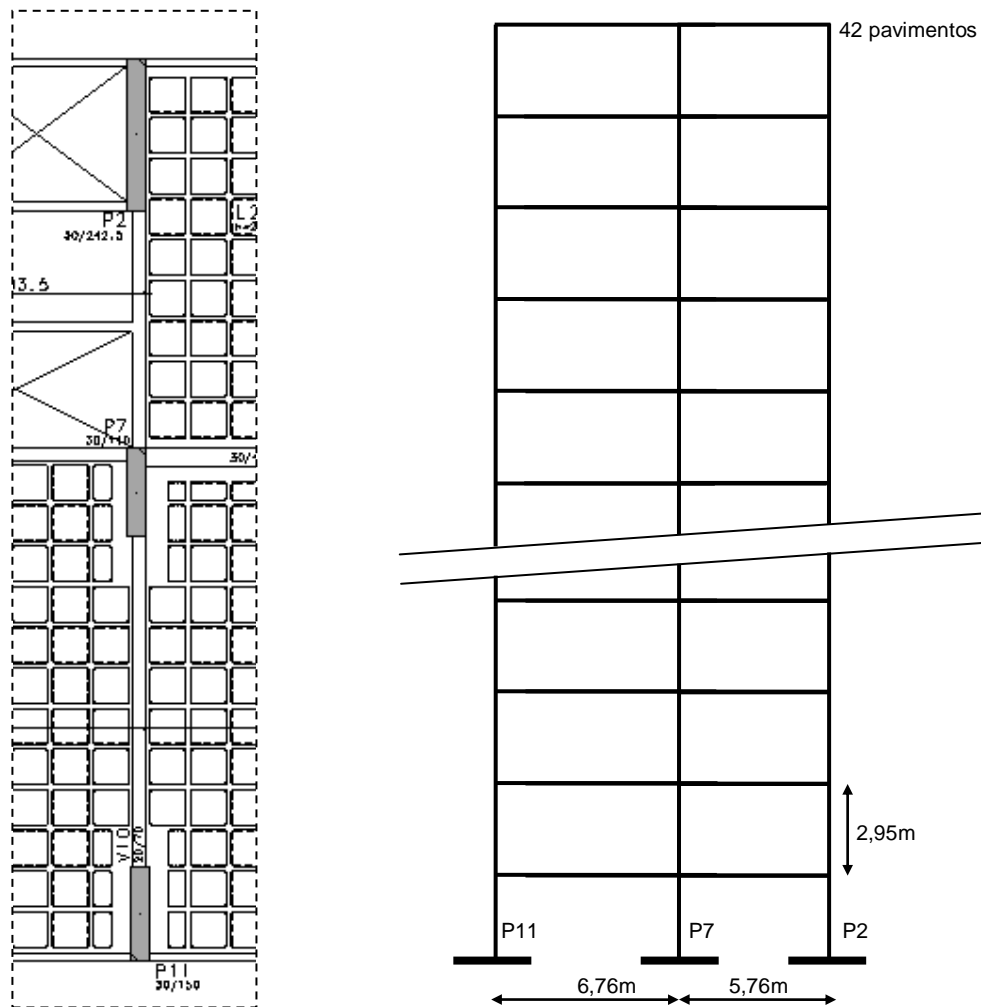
Trecho da planta baixa de forma e pórtico plano – Edifício 3
